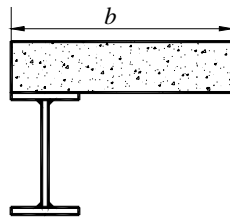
Largura efetiva b quando a laje se estende para apenas um dos lados da viga
